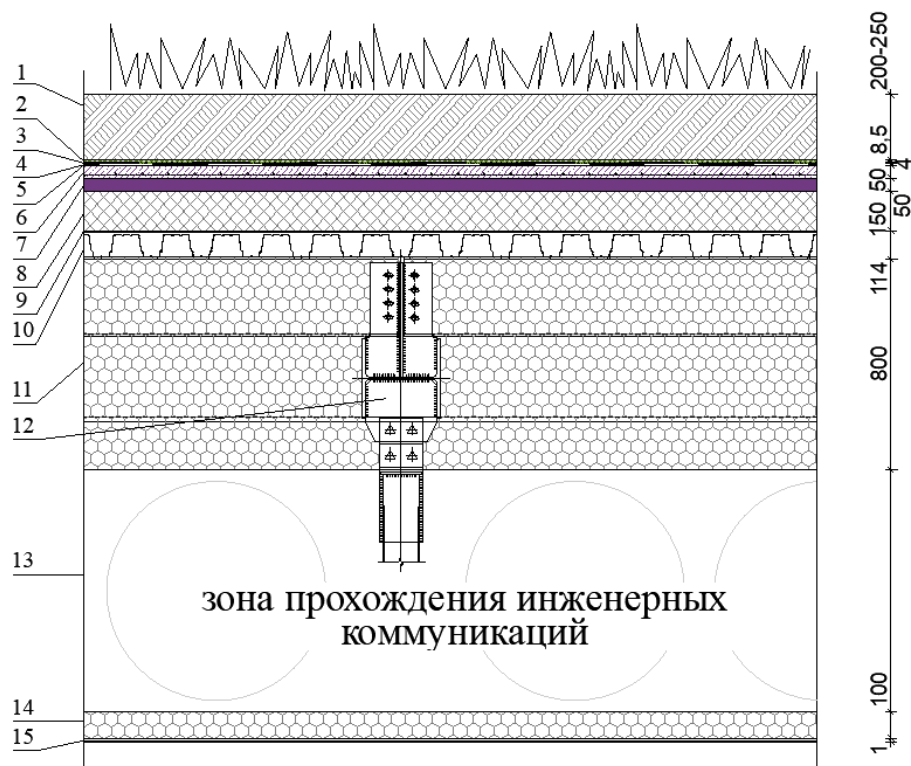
Конструкция полунтенсивной озелененной кровли по профнастилу:
